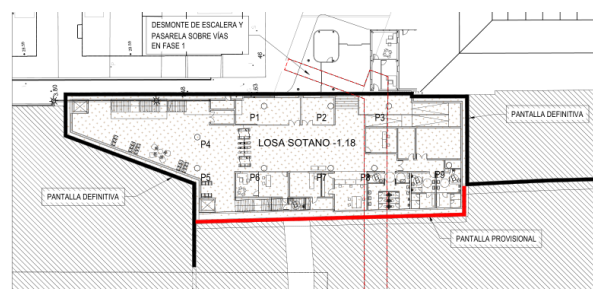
Planta de la fase constructiva de ejecución de la estación provisional.
